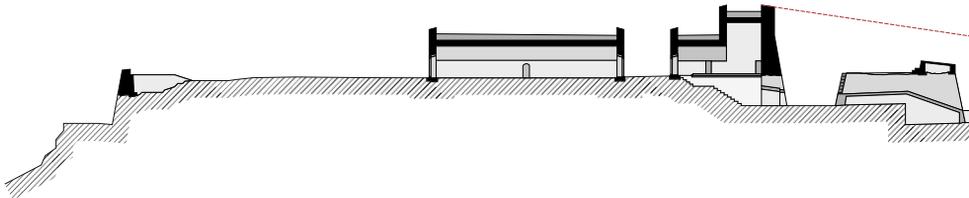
Perfil seccionado 3-3'-4' / Elaboración propia.
